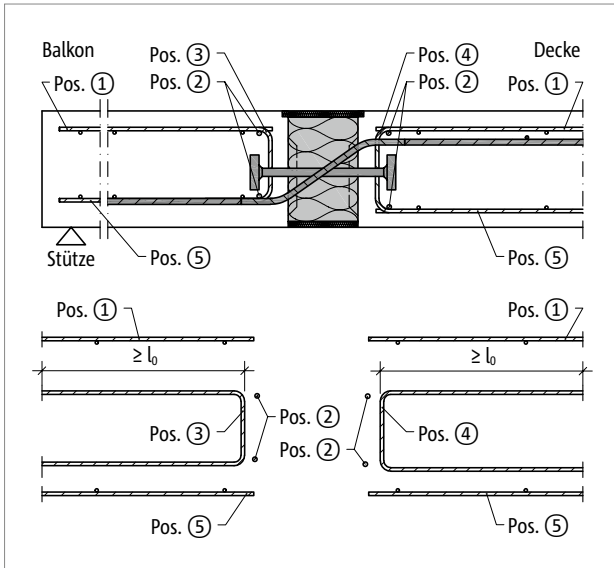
Schöck Isokorb® XT Typ QP: Bauseitige Bewehrung
